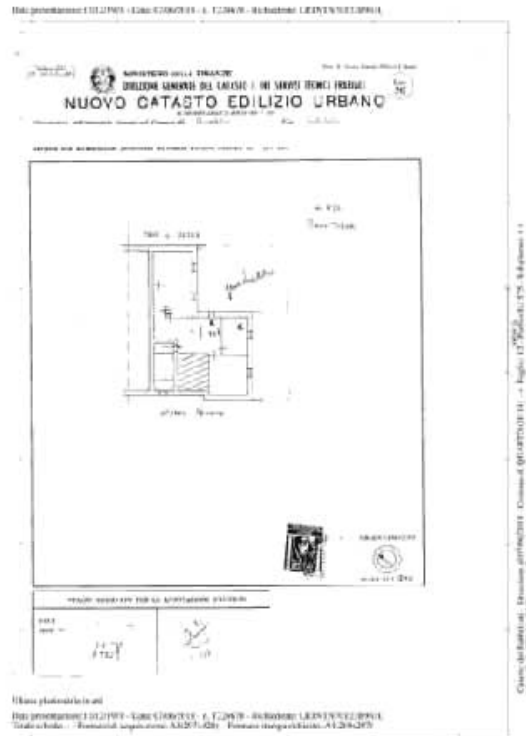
Planimetria catastale appartamento al piano terra (12.12.1978)
